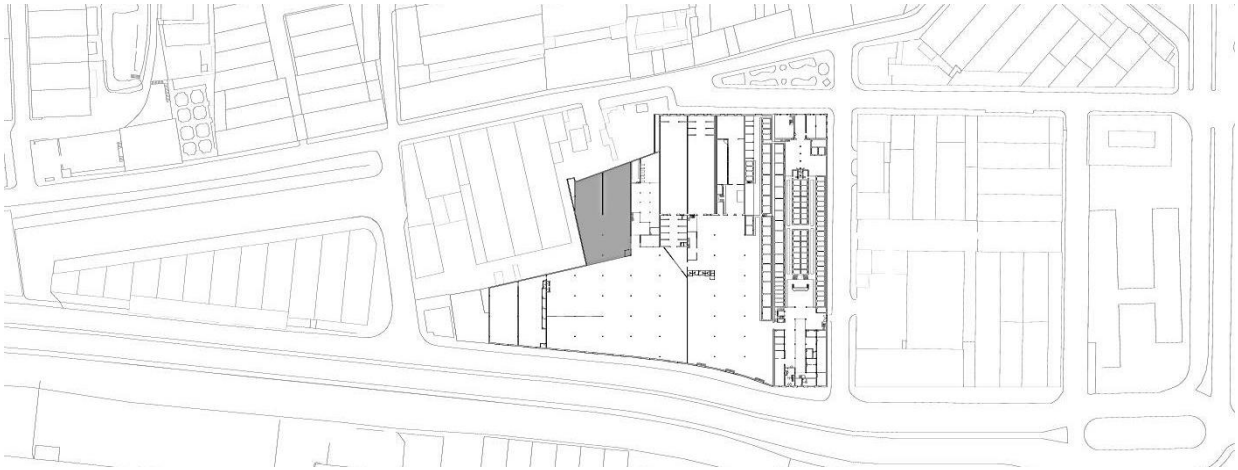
Planta de levantamento fotográfico piso térreo – Armazéns 15 e 17.
